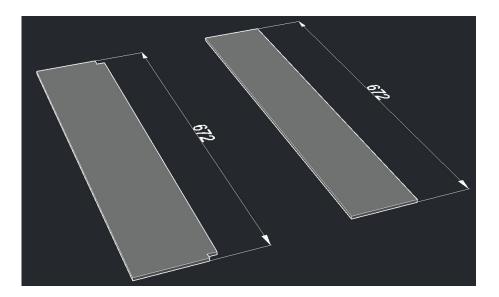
Tipos de losas destinadas al sector departamento. Fuente: Elaboración propia.
